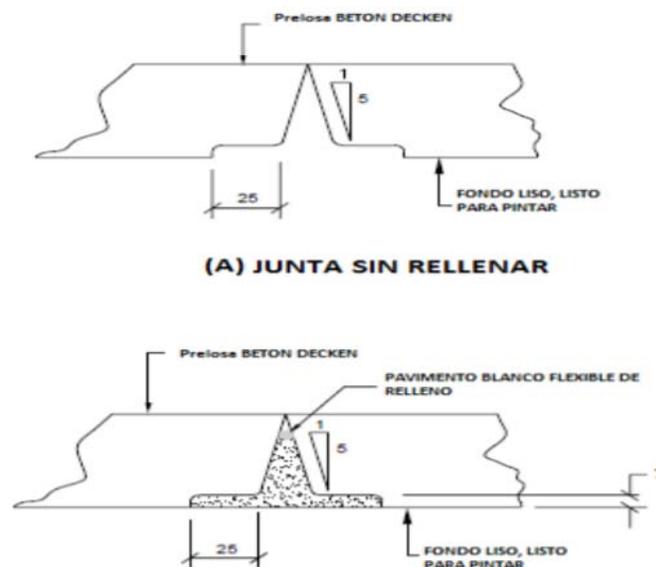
Prelosa Beton Decken con acabado liso. Fuente: Beton Decken (2016) –
